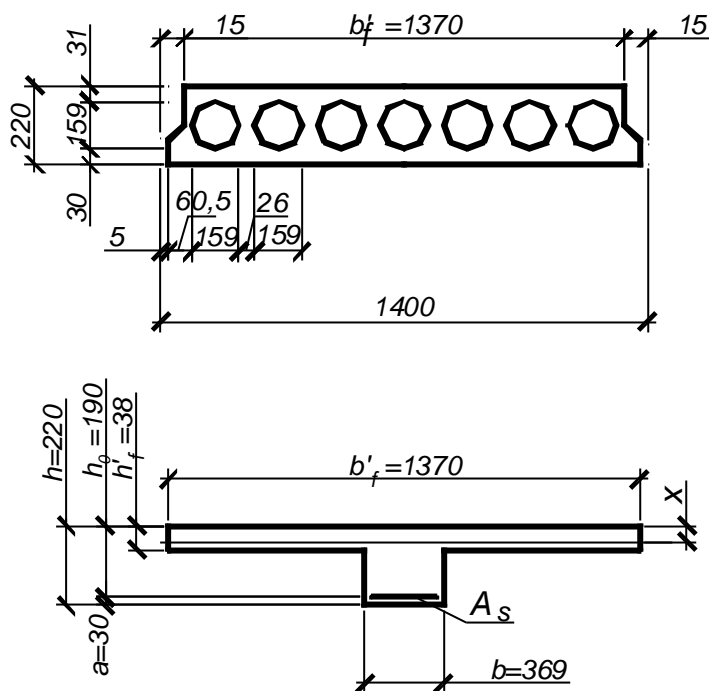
Поперечний переріз плити з круглими порожнинами
